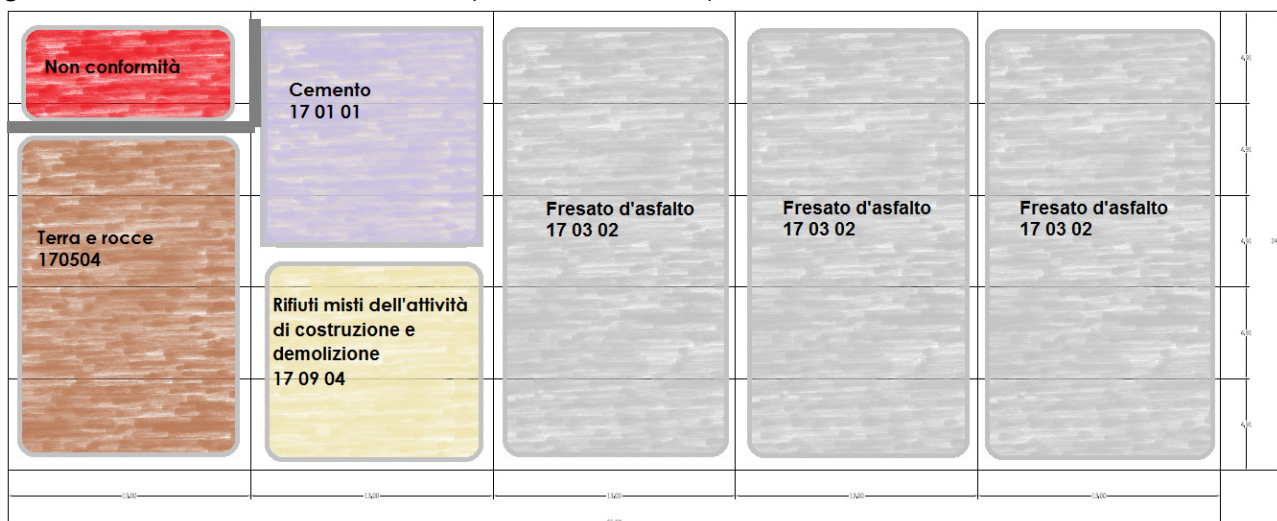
Schema planimetrico della organizzazione interna della pensilina 1
